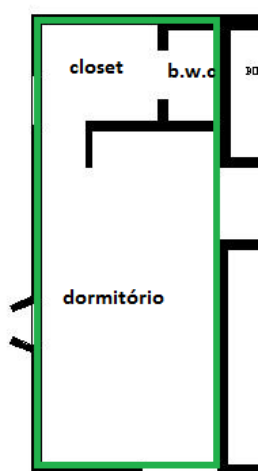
Esquema da planta baixa do apartamento do edf. Saveiro. Setor íntimo em formato de “I”.
